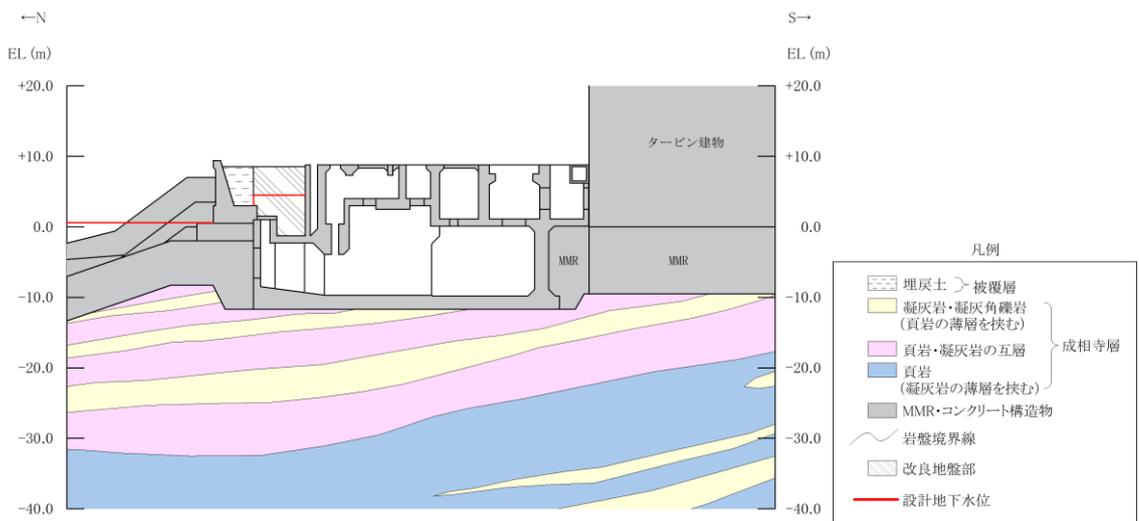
(3) 取水槽 地質断面図 (D-D 断面)
